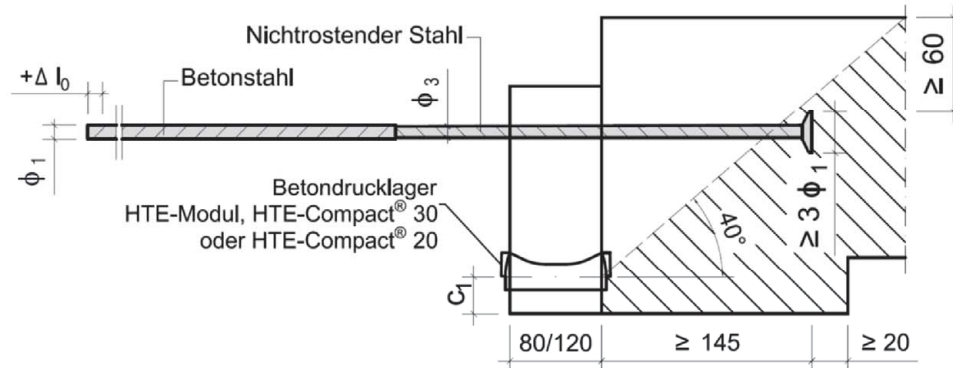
Zugstab für Schöck Isokorb® Typ K-U und Typ K-U-F mit Durchmesserkombination und Lage des Ankerkopfs
